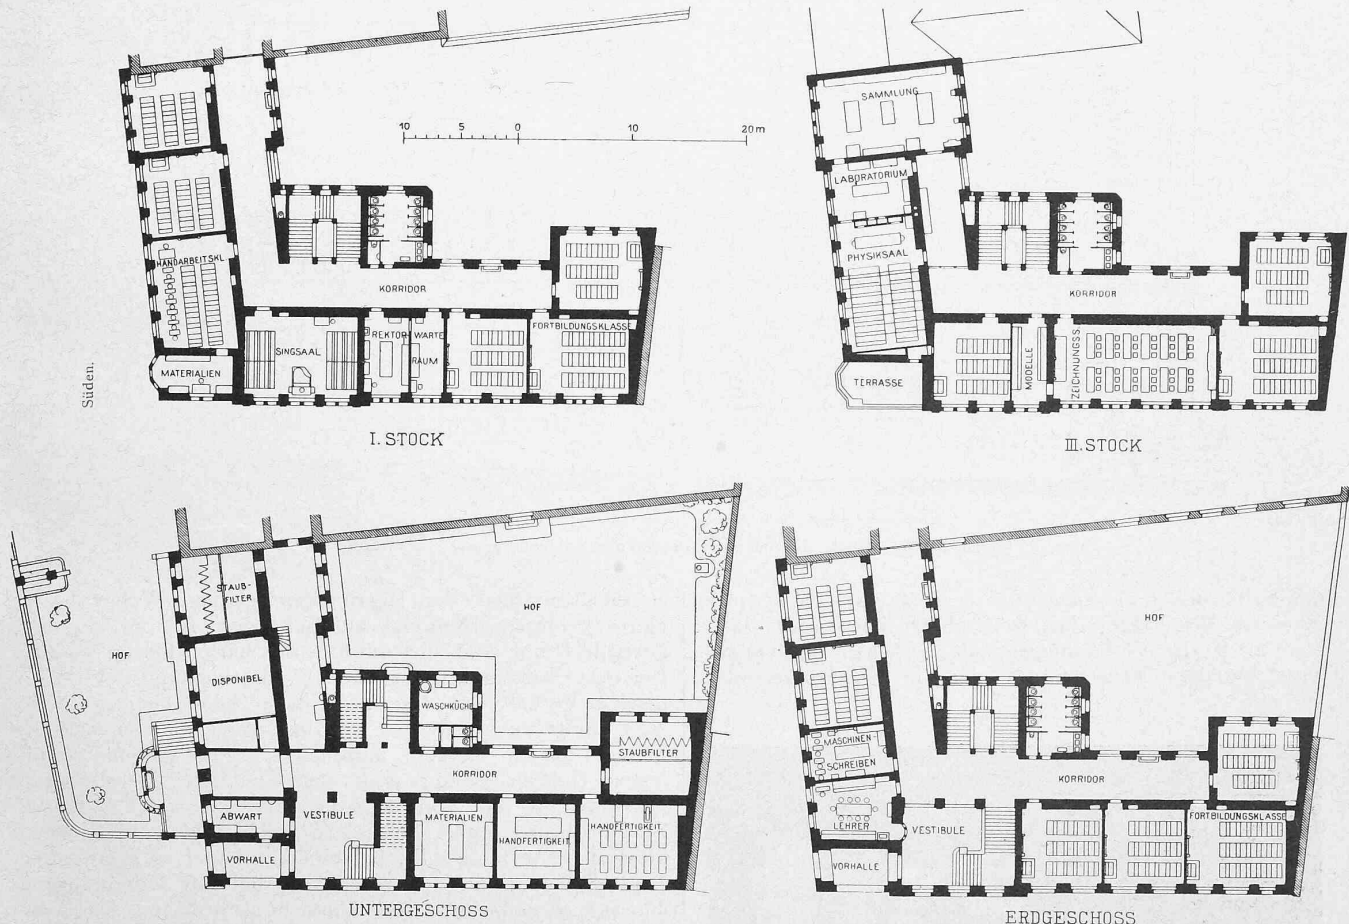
, 4, 5 und 6. Die hauptsächlichsten Grundrisse des Gebäudes. — Masstab 1 : 600.
